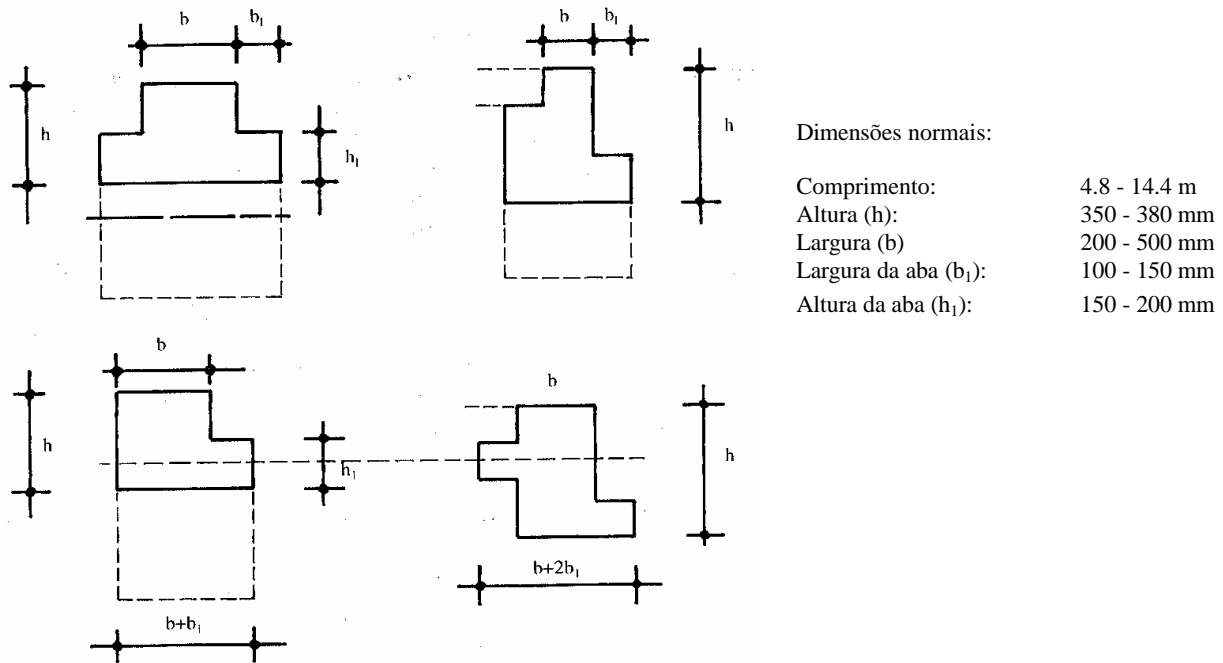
Seções típicas e dimensões em vigas com abas invertidas para pisos
